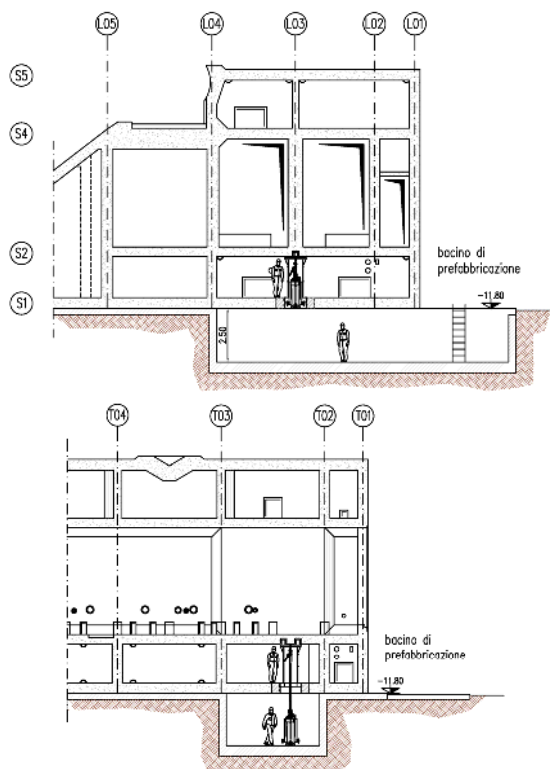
Piazzale di prefabbricazione: pozzo di accesso all’area martinetto di livellamento – sezione trasversale e longitudinale in L03 - fasi di montaggio dei martinetti.
